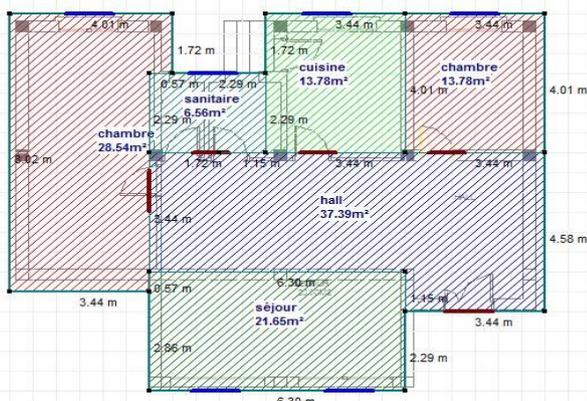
plan d'une maison quelconque dessiné sous alcyon (source : auteur).
